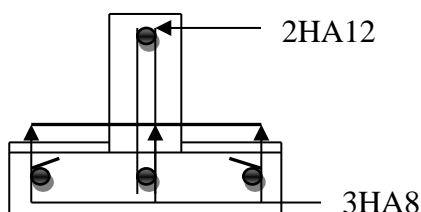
Disposition des armatures dans la poutelle (Appui ; travée)
